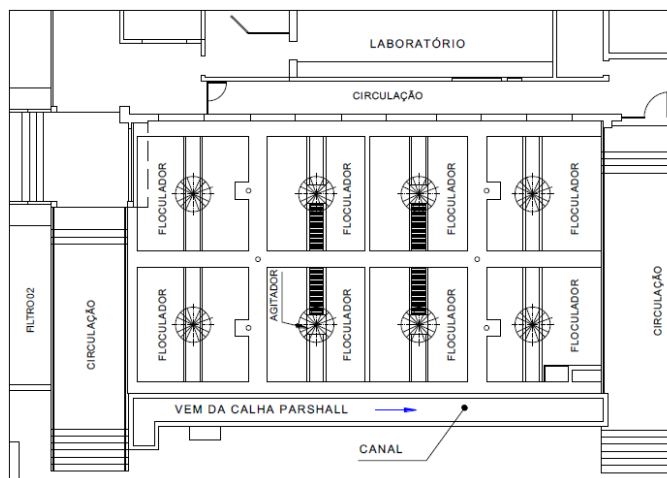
Plantas dos Floculadores (Fonte: TECNOSULT, 2017)
